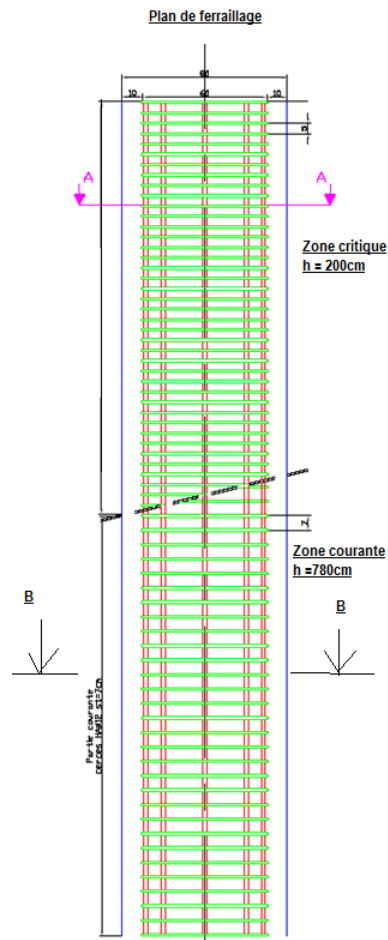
Coupe longitudinale des armatures des pieux.
